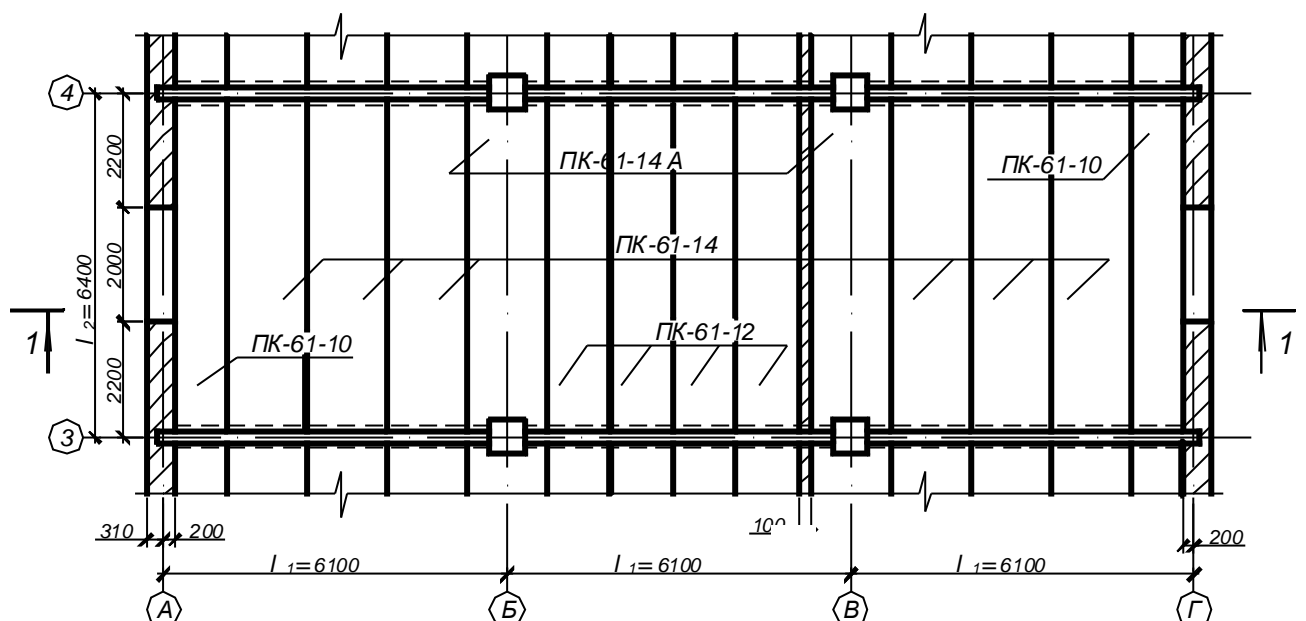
Приклад компоновки збірного перекриття (фрагмент)
